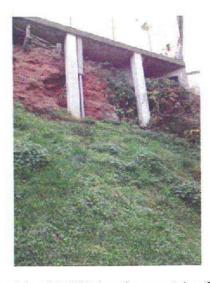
Piliers soutenant la terrasse de M. et Mme SALHING et renforcement du refend. Noter l'absence de parade contre les chutes de blocs.
